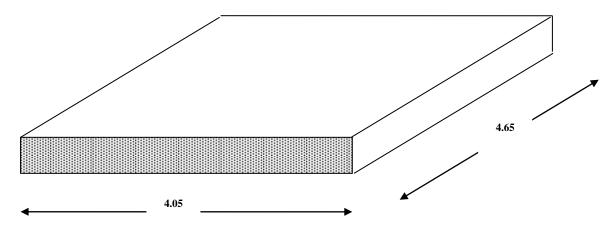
Vue en plan illustrant les dimensions du panneau le plus sollicité.
